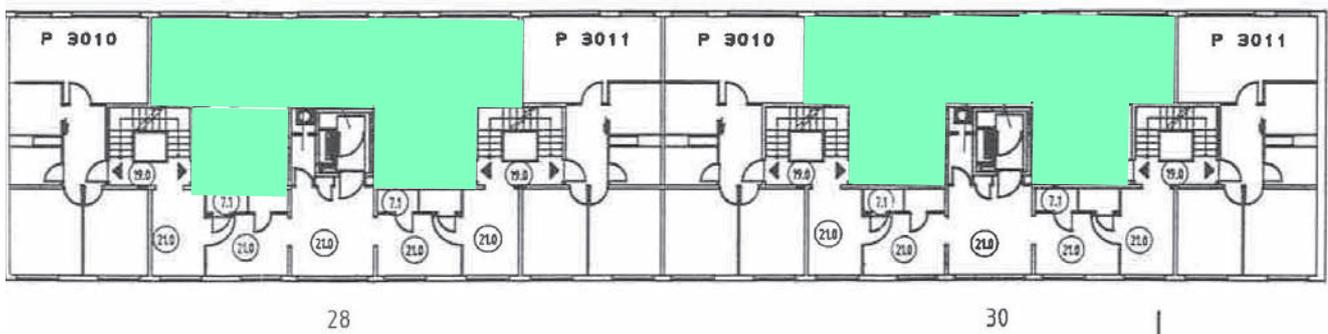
Grundrisse Michaelkirchstraße 28-30
